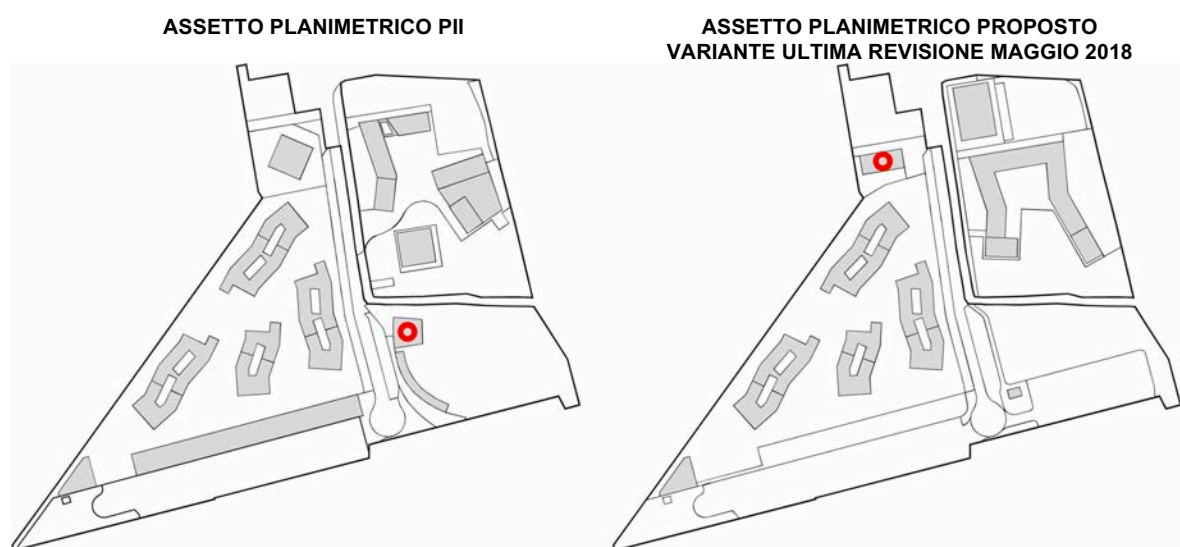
| A sinistra, l'ubicazione dell'asilo/struttura polivalente secondo la planimetria del PII vigente e, a destra, la proposta di nuova collocazione prevista dalla variante ultima revisione maggio 2018.
